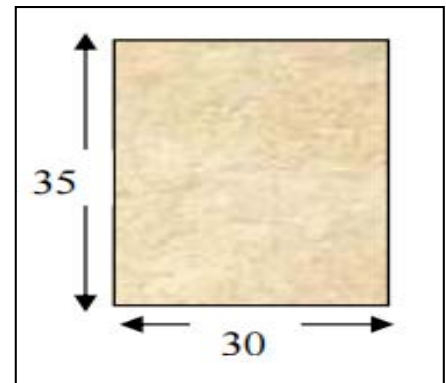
Coupe 2ème type du Poutre Secondaire (30x35)
